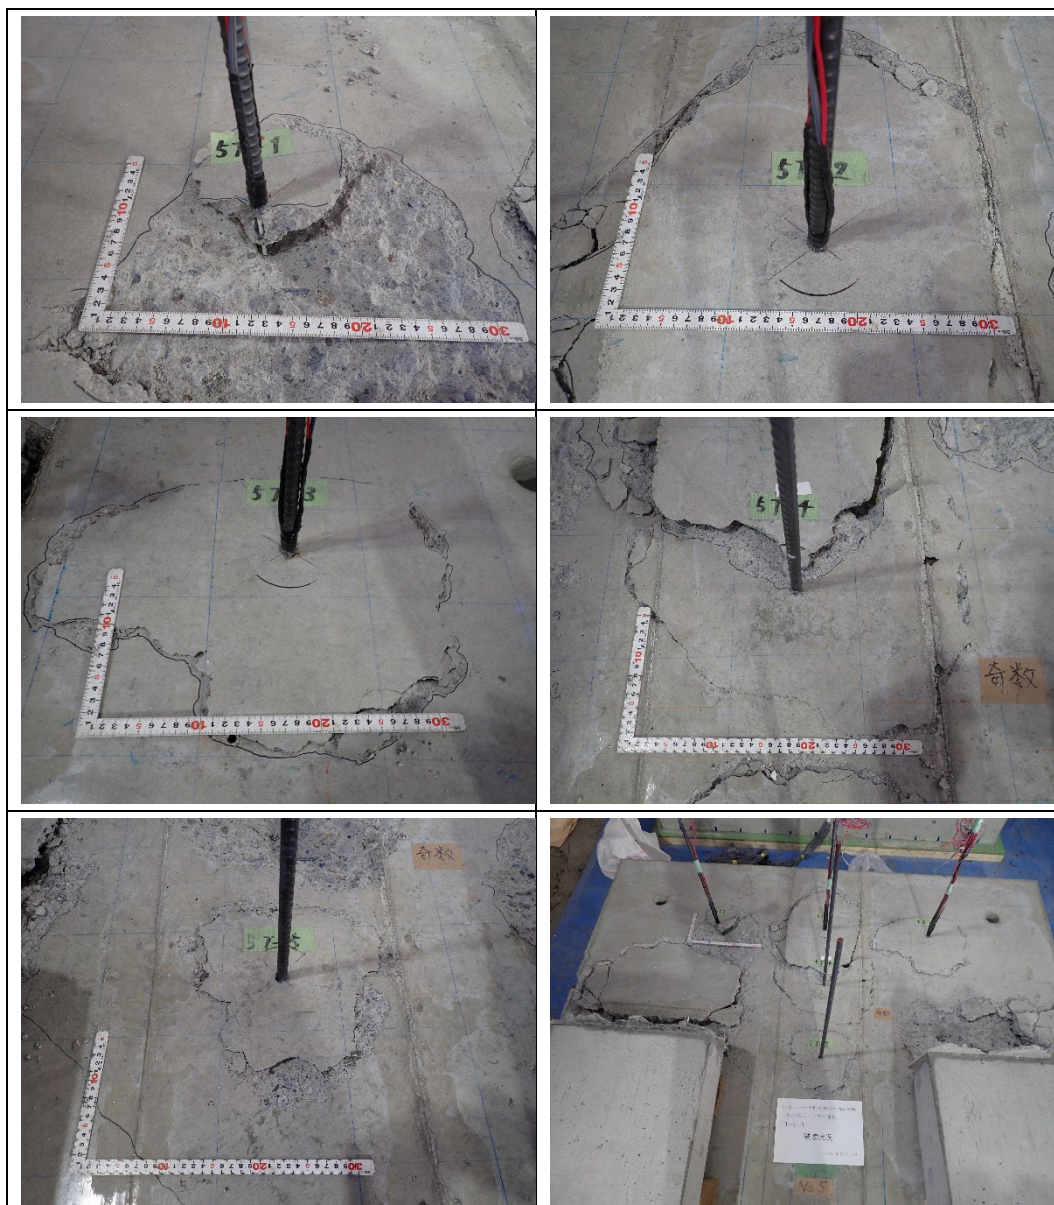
あと施工アンカー単体実験破壊状況 (5T-1～5T-5)
